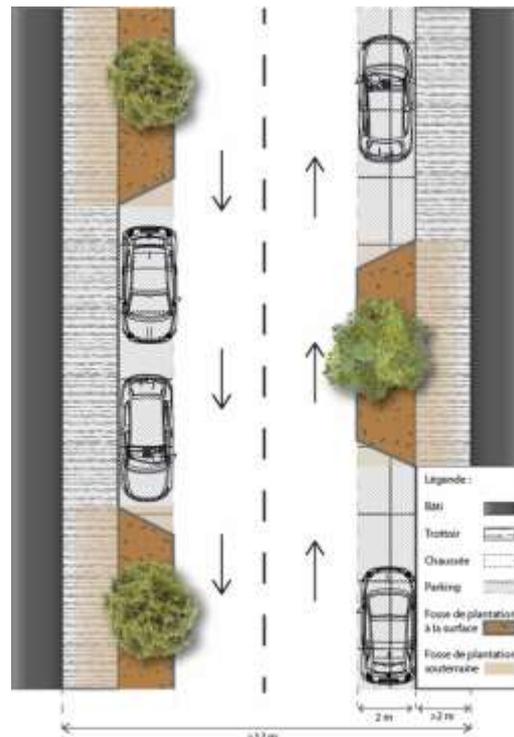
Exemple de plan de voirie double sens avec extension de la fosse de plantation sous le trottoir. (M. Cornut, 2020).
